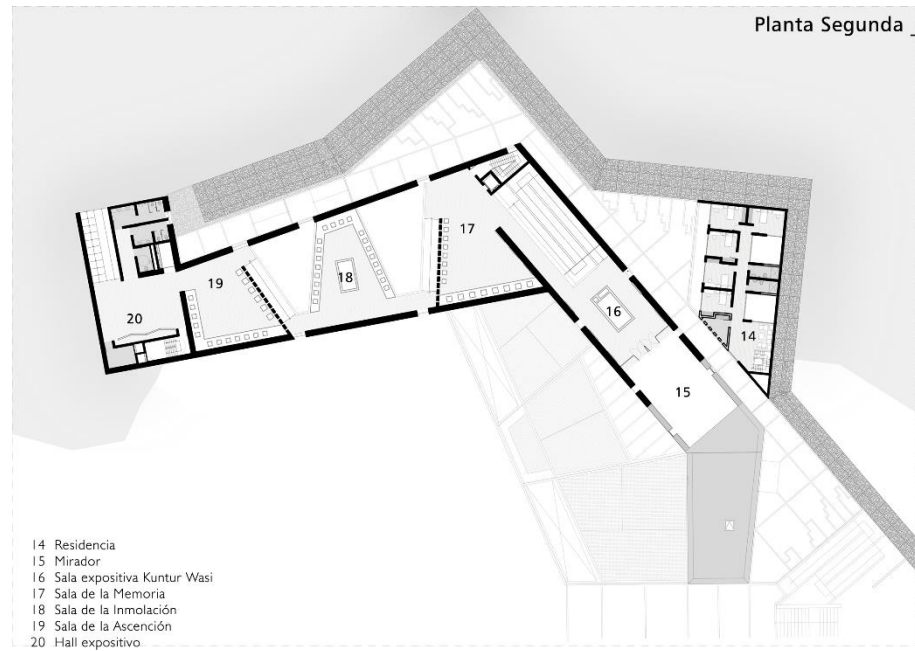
/ Planta segunda. Fuente: Elaboración propia.
